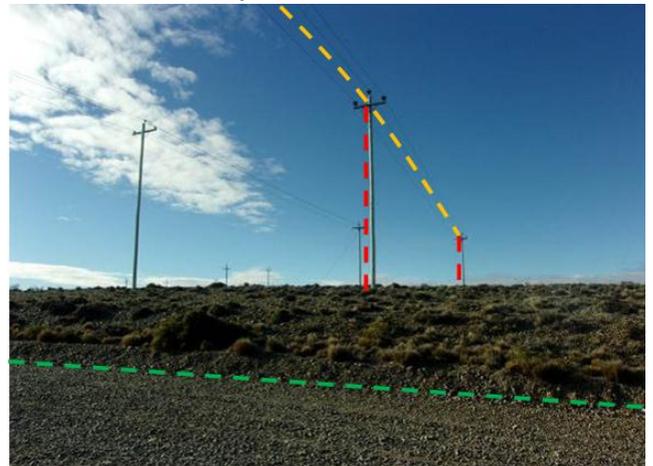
Fotografía III.C-100. Línea eléctrica (naranja) atravesando un drenaje. Foto en dirección SE.
